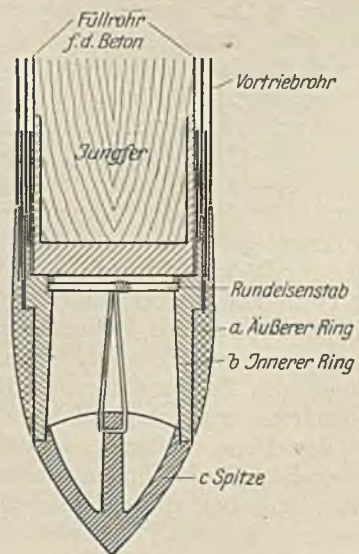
Pfahlspitze des Ortpfahls Bauart Zimmermann.
